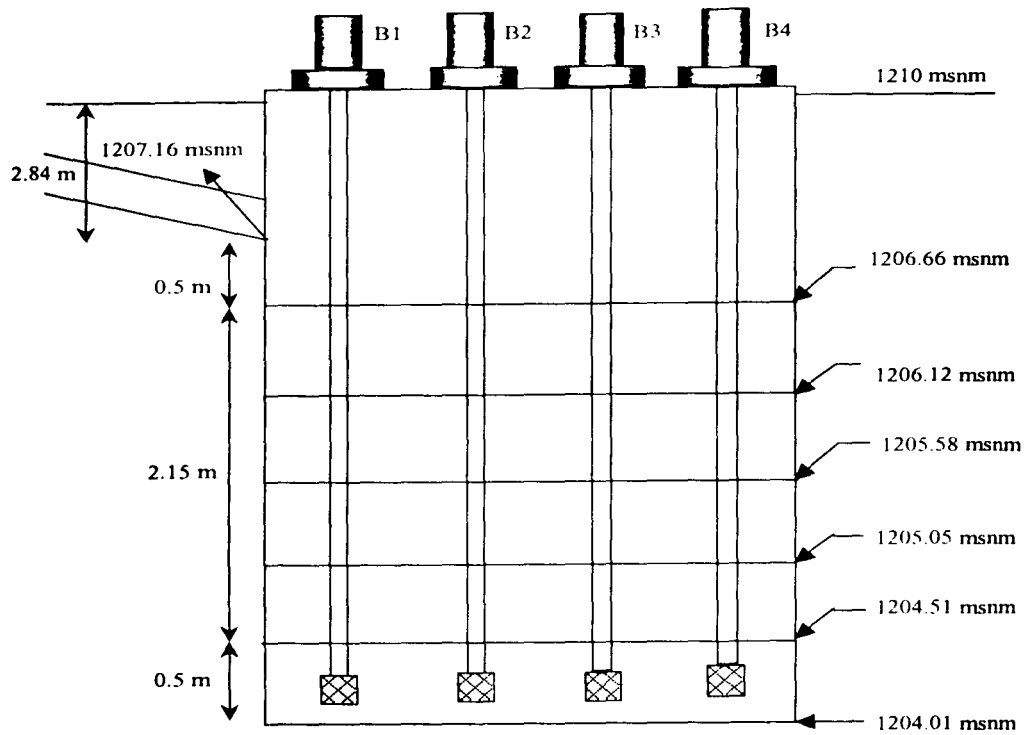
Perfil del cárcamo de bombeo para la planta de tratamiento.
